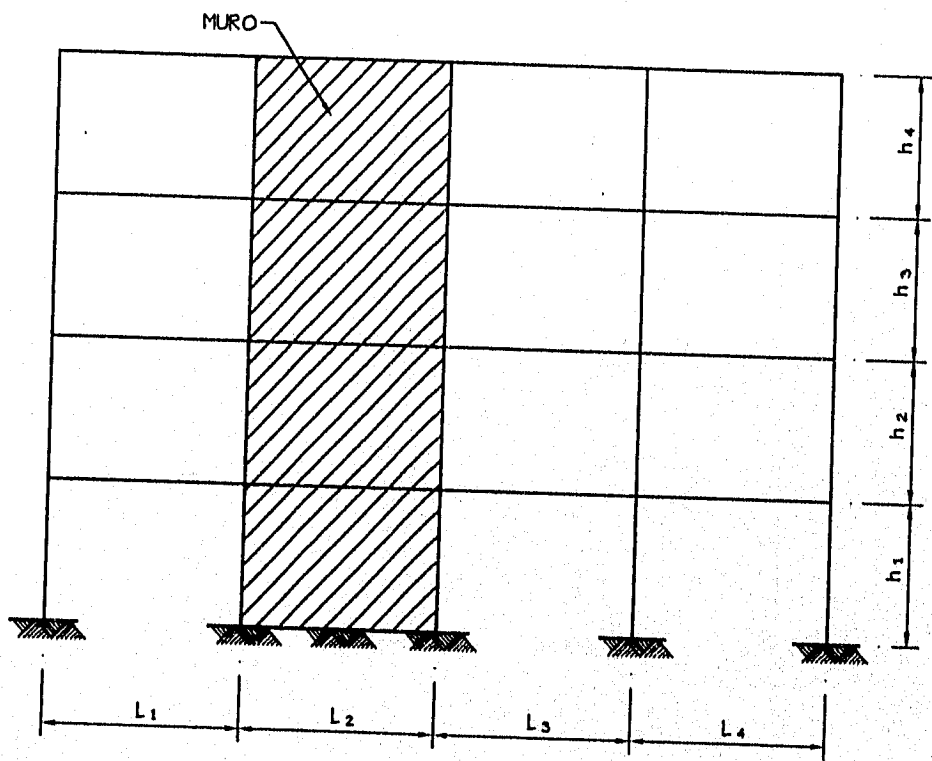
SISTEMA DE MARCO RIGIDO CON MURO
